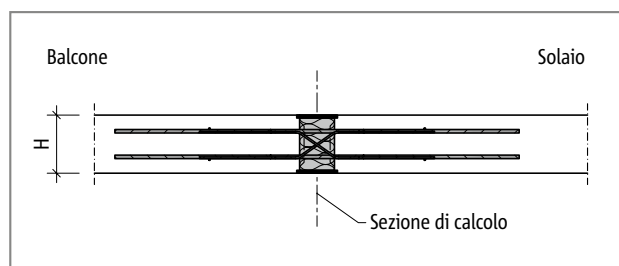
Schöck Isokorb® XT tipo DL: schema statico
